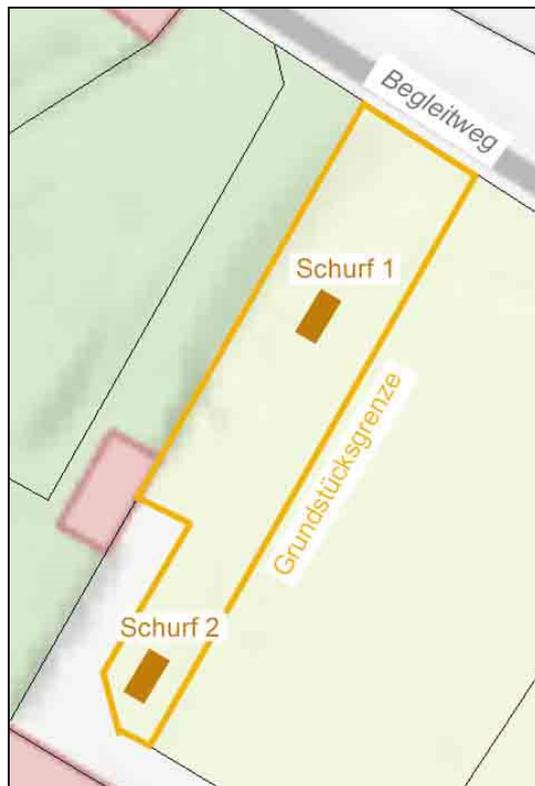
Lageplan (Situierung der Bodenaufschlüsse)
